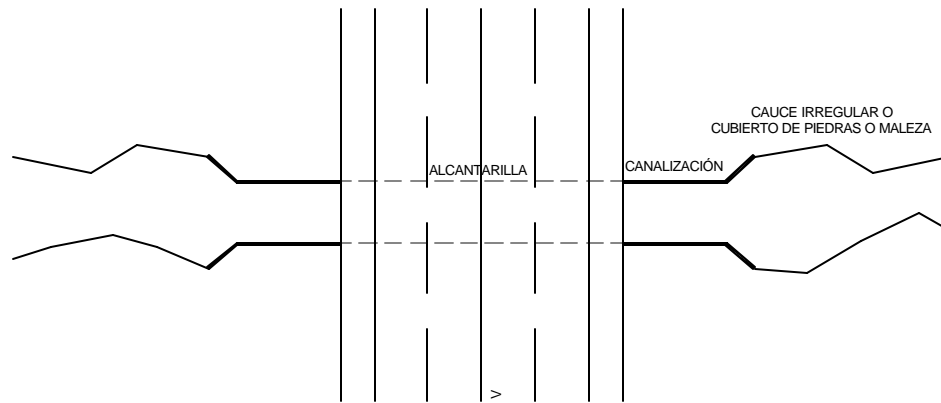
Canalización a la entrada y salida de la alcantarilla por cauce irregular o cubierto de piedras o maleza.
